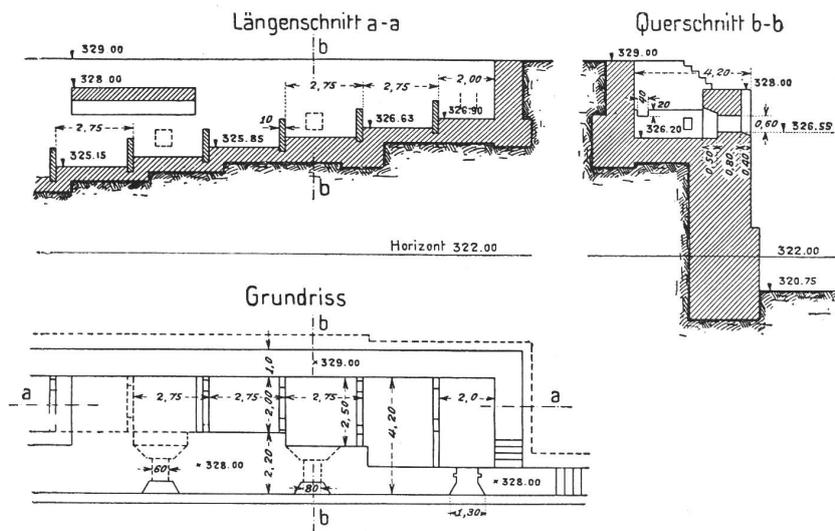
Stauwehr des Elektrizitätswerkes Beznau. Grundriss und Schnitte durch die Fischrepppe. Maßstab 1 : 250.
